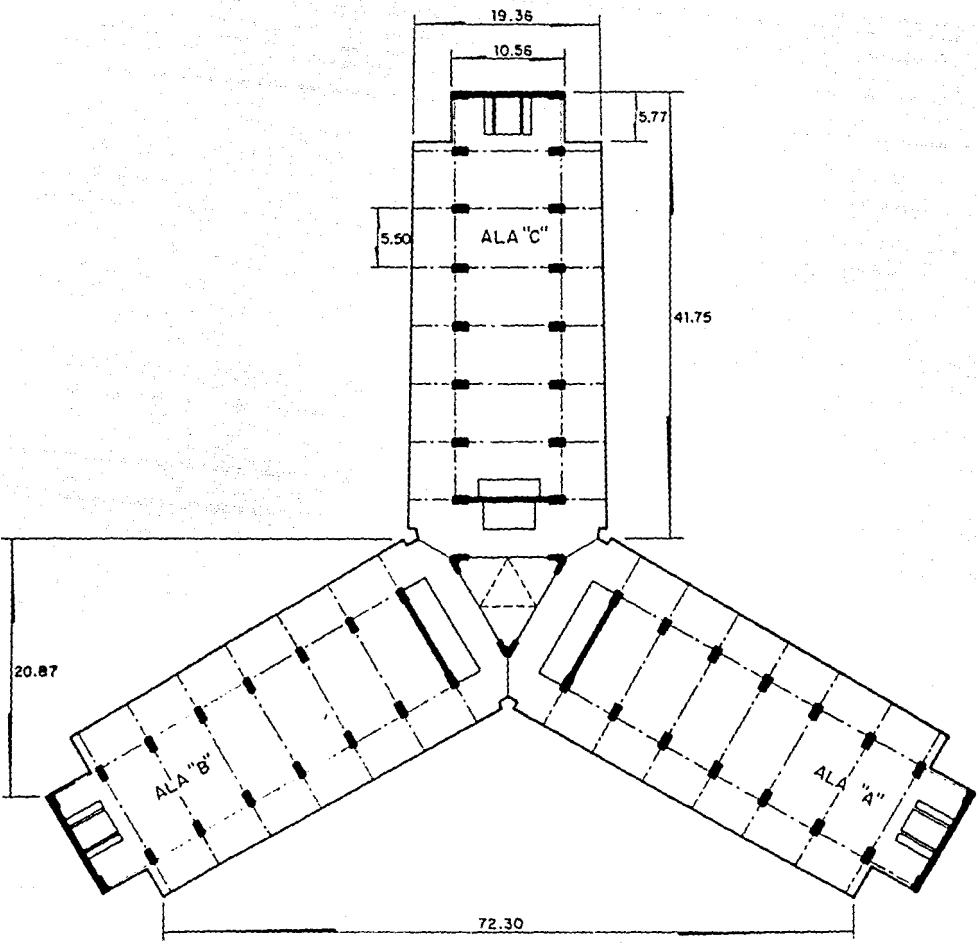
Planta tipo de los dos primeros niveles del edificio.
